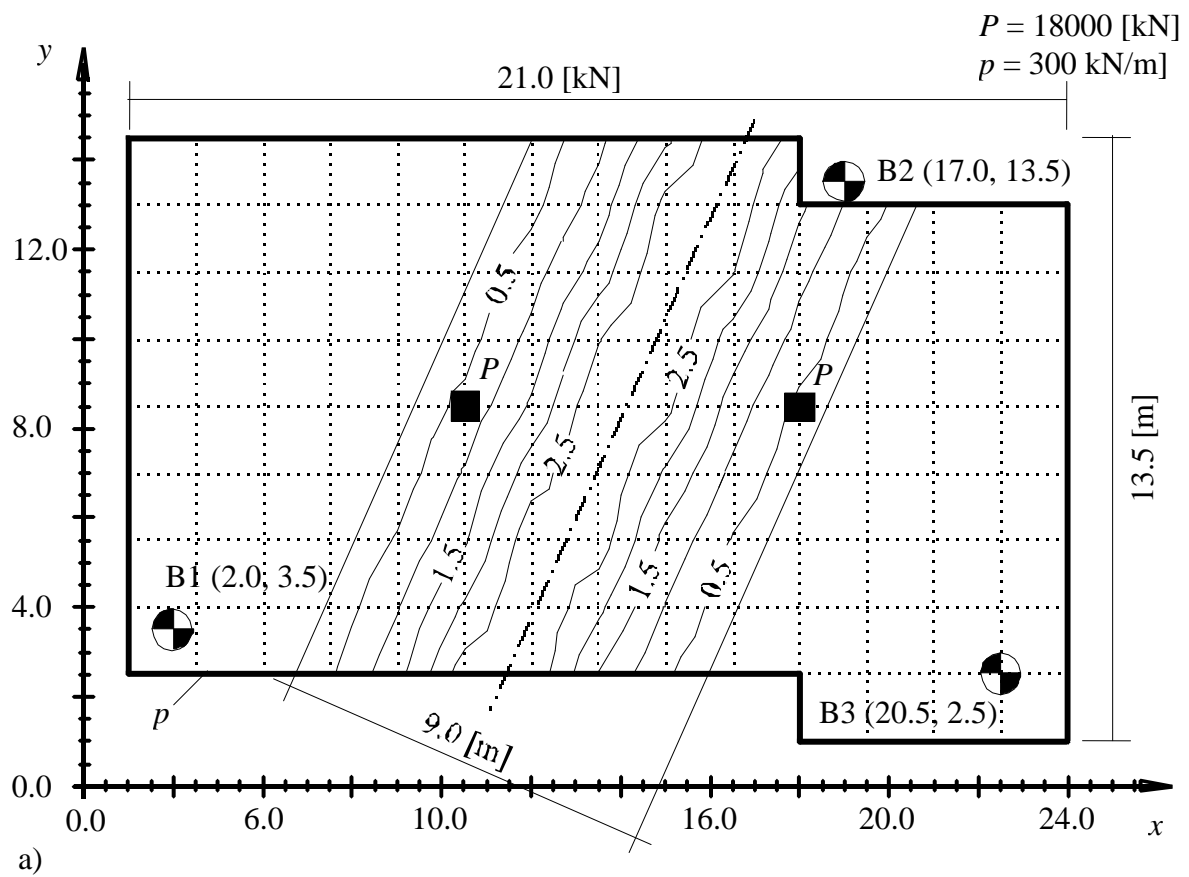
a) Lageplan mit Setzungslinien durch Untertunnelung und Bohrpunkte
